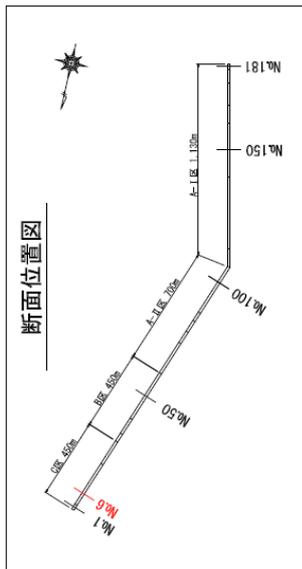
No.1 沖防波堤の平面図 A-I-3区～A-I-6区 (被災後・復旧後)
